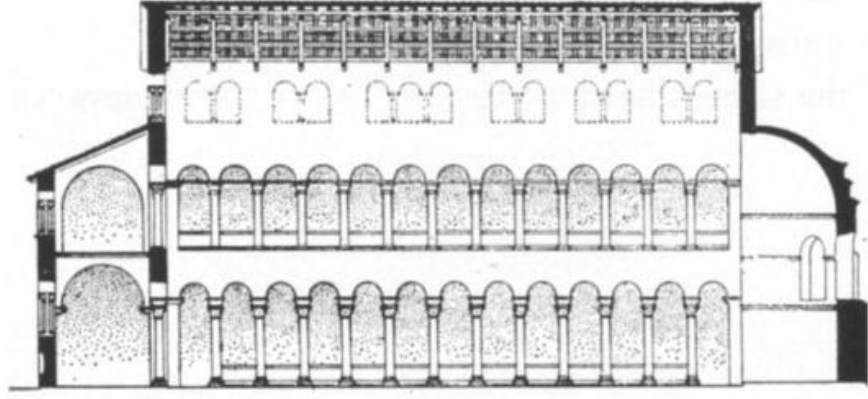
Studios Bazilikası'nın planı (Ebersolt ve Thiers, 1913, Pl. I).
